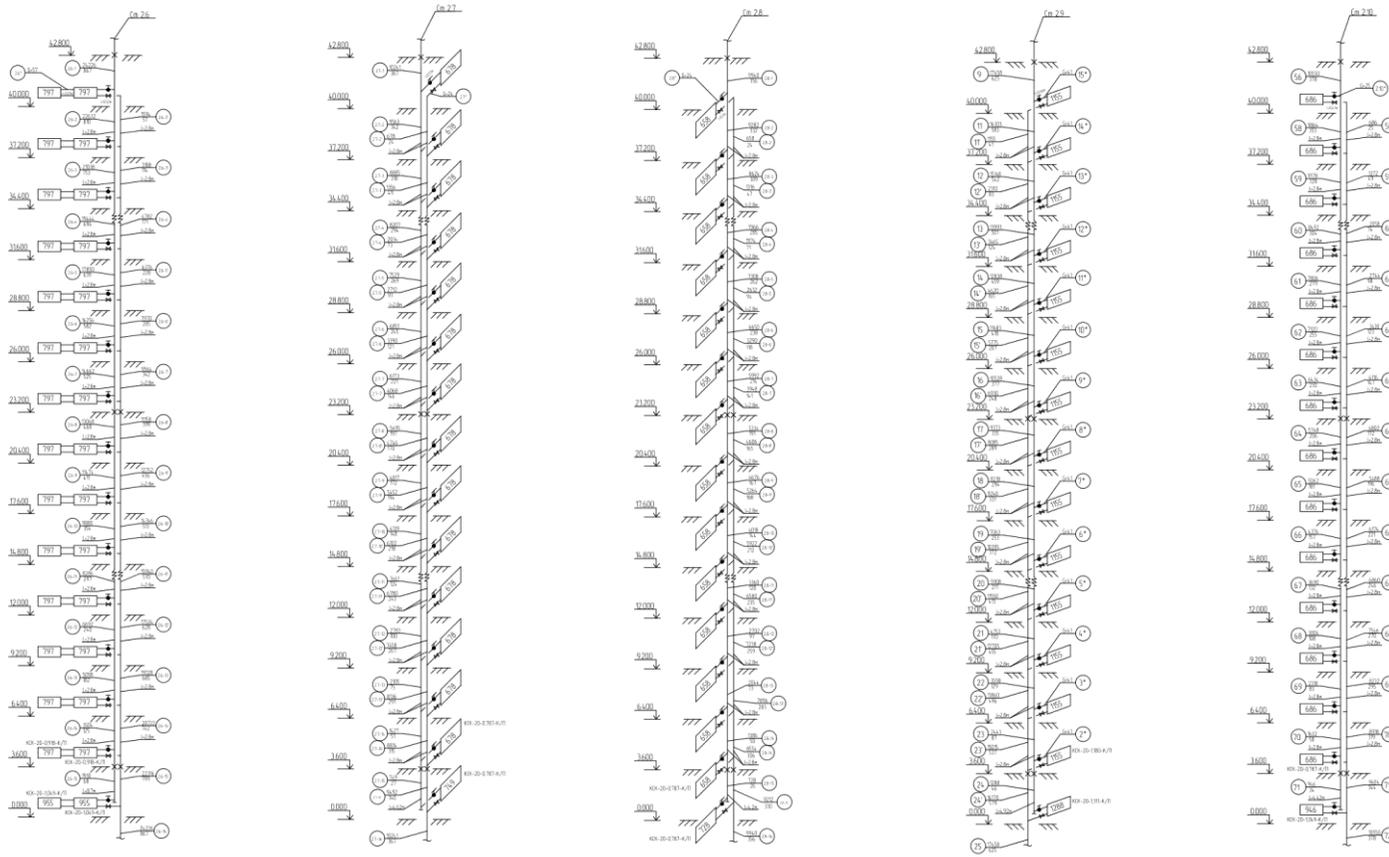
Расчетная схемы стояков 2.6-2.10
